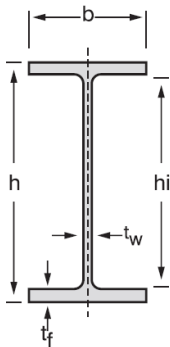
Perfil por utilizar para la viga principal, Aceros Ocotlán,2017, Vigas IPR www.acerosocotlan.mx.
